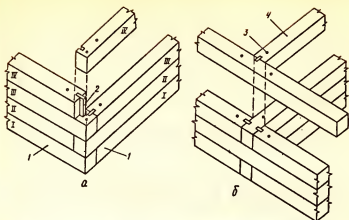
Схемы сопряжения брусьев наружных (а) и наружной и внутренней (б) стен на вкладных шпонках:
